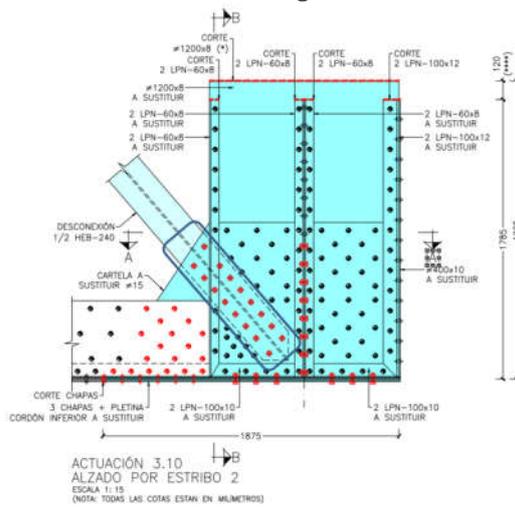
Nudo inferior mamparo de pila. Desatornillado de diagonales
